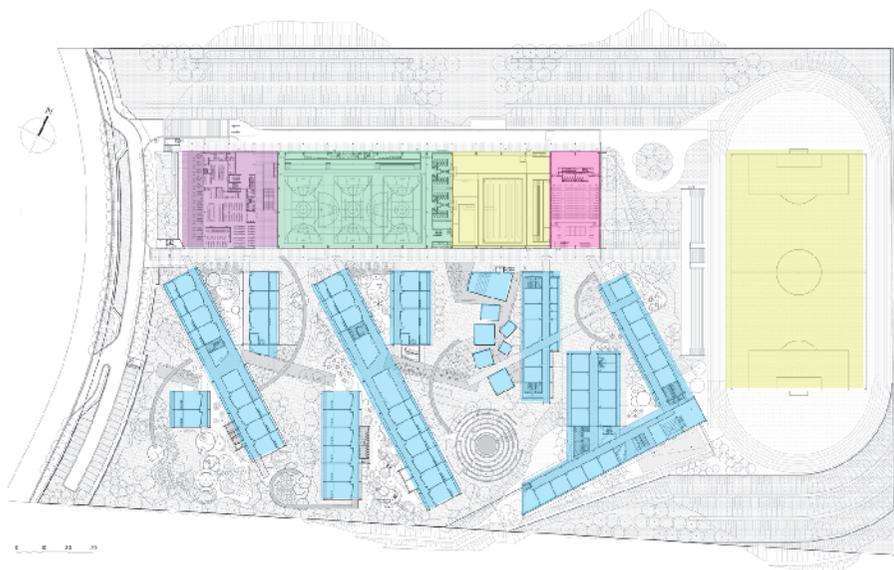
Planta baixa do projeto - Modificada pelo autor
